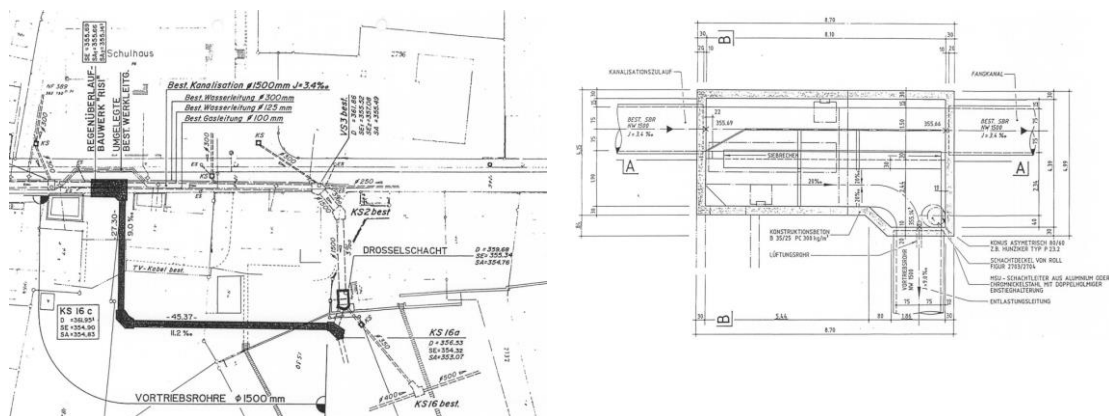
Situationsplan und der Grundriss des Überlaufbauwerks
